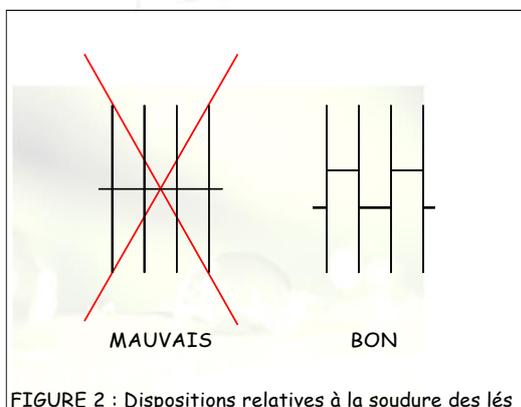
Dispositions relatives à la soudure des lés
